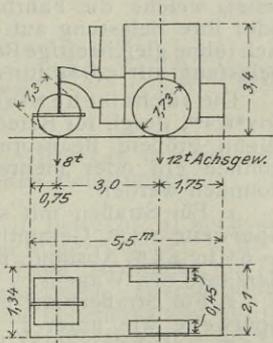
Dampf-Straßenwalze für Staats- und Distrikts-Straßen.
